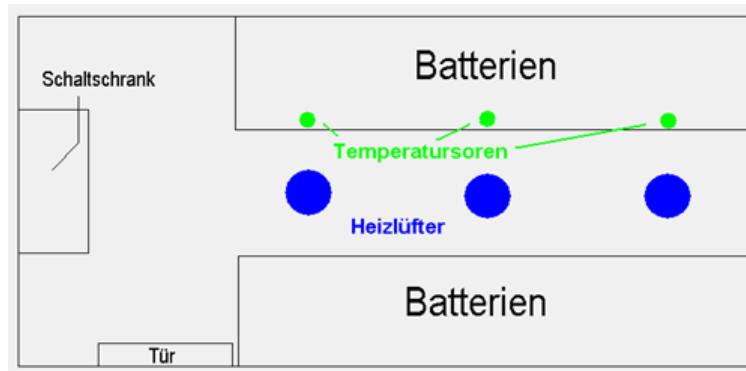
Draufsicht Innenraum ECU, Position der PT1000-Sensoren und Heizlüfter
